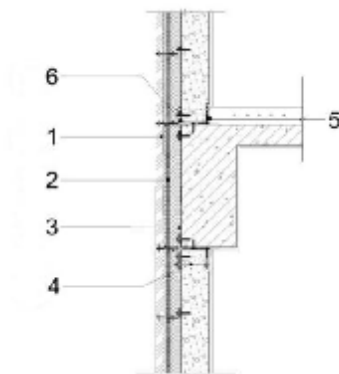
保温装饰复合蒸压加气混凝土一体外墙板工程梁柱部位保温措施示意图
